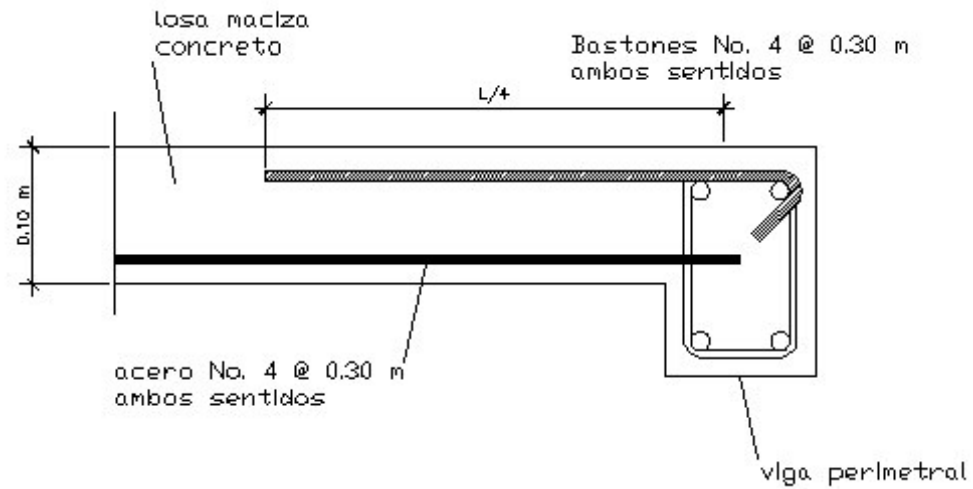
Sección de corte de armado de losa densa de 4 x 3 m
